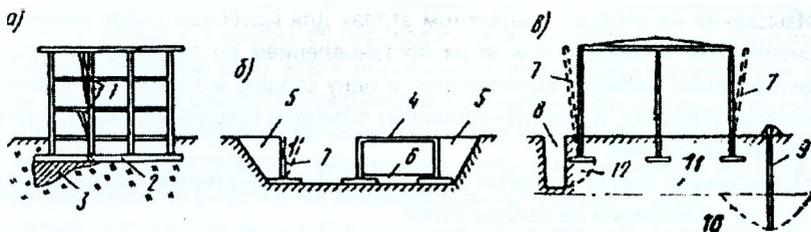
Деформации сооружений в процессе производства работ: 1 - трещины; 2 - фундаментная плита; 3 - неуплотненный грунт; 4 - перекрытие; 5 - обратная засыпка; 6 - пол подвала; 7 - деформированные конструкции; 8 - траншея; 9 - иалофильтр; 10 - депрессионная кривая; 11 - уровень подземных вод; 12 - призма выпора.
